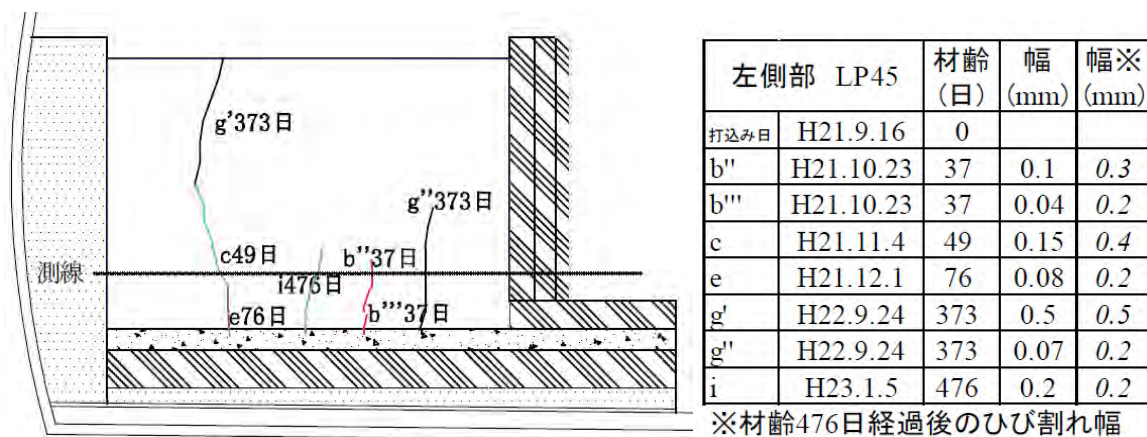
側部低拡散材（LP45 配合）のひび割れ状況（側面図）
